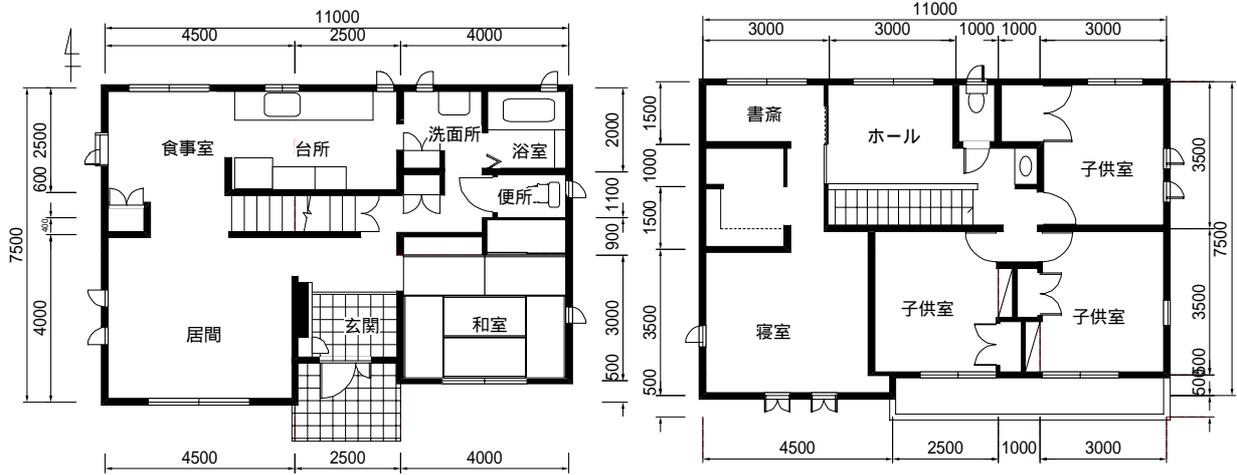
九州・沖縄 戸建 05 平面図 [単位：mm]
